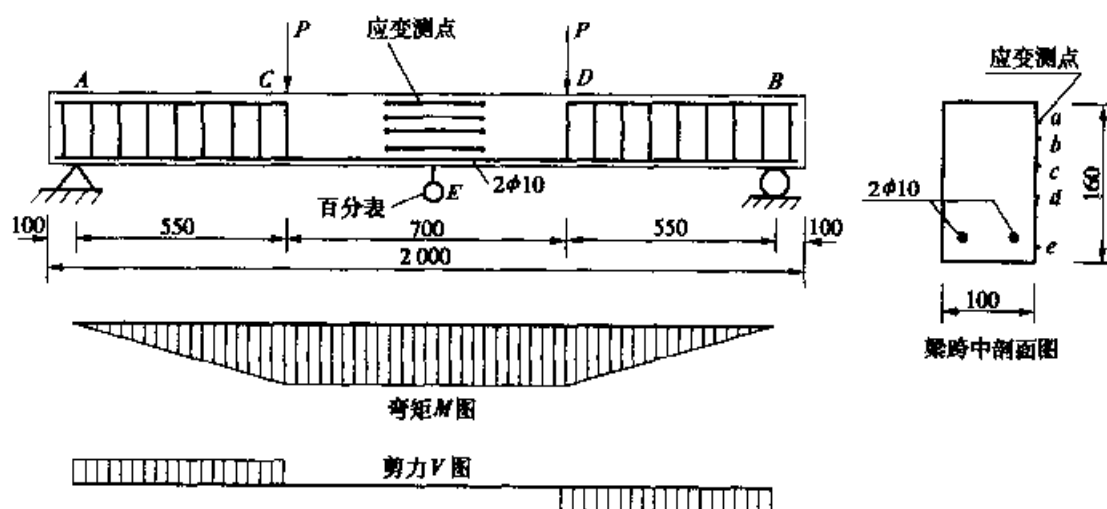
钢筋混凝土试验梁(尺寸单位:mm)
